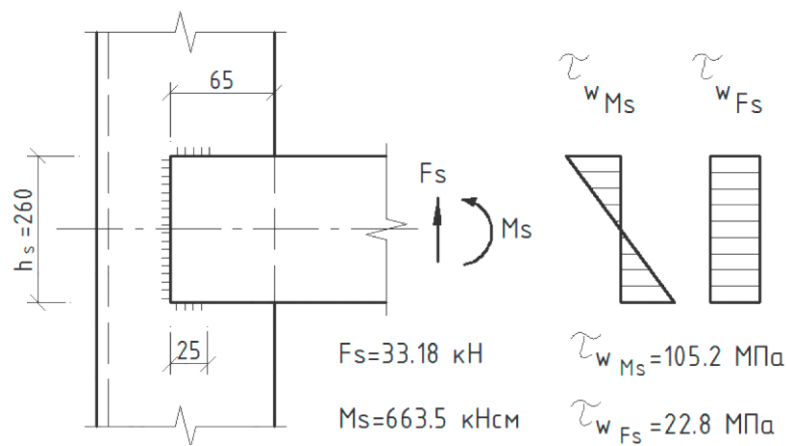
До розрахунку кріплення планки до вітки колони зварними швами
